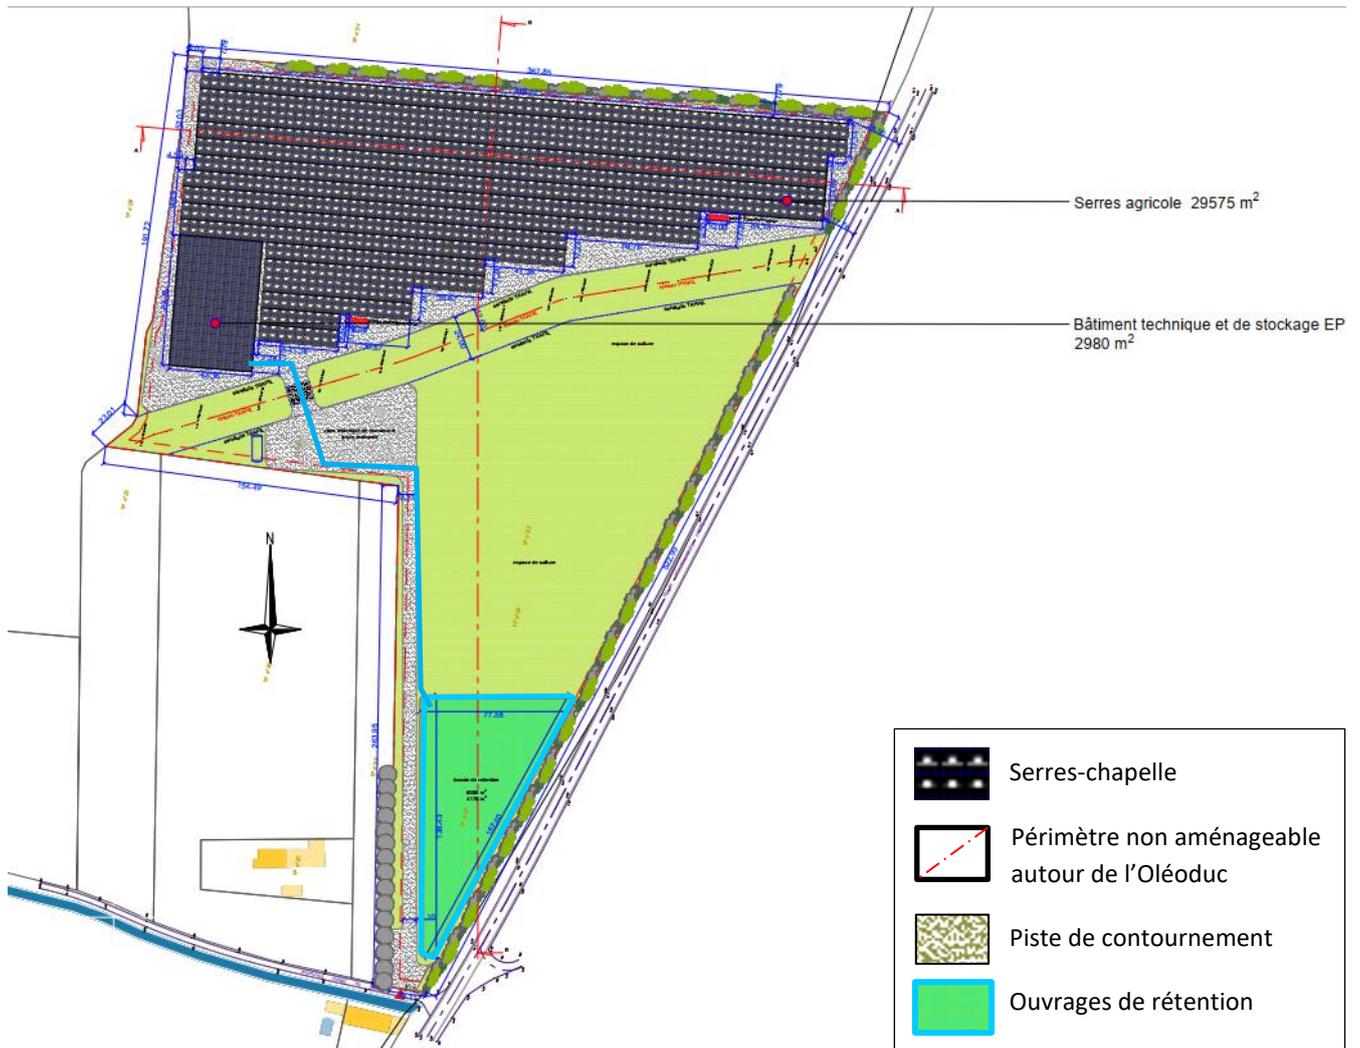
Plan de masse de la disposition des infrastructures du projet
